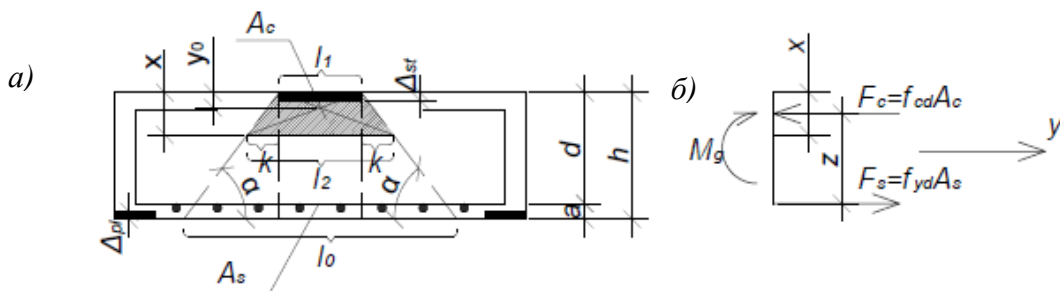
Розрахункові схеми: а) перерізу з одиночним армуванням;
